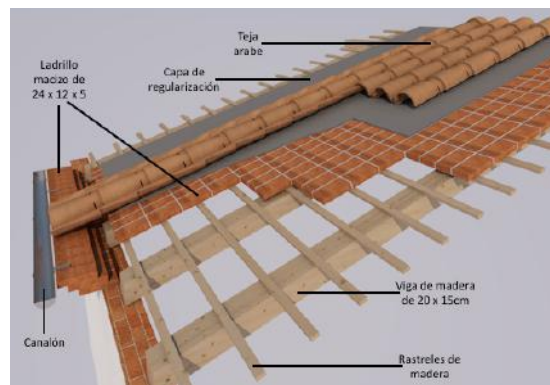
Detalle cubierta - Alero. 2016. Realizado por el alumno.
